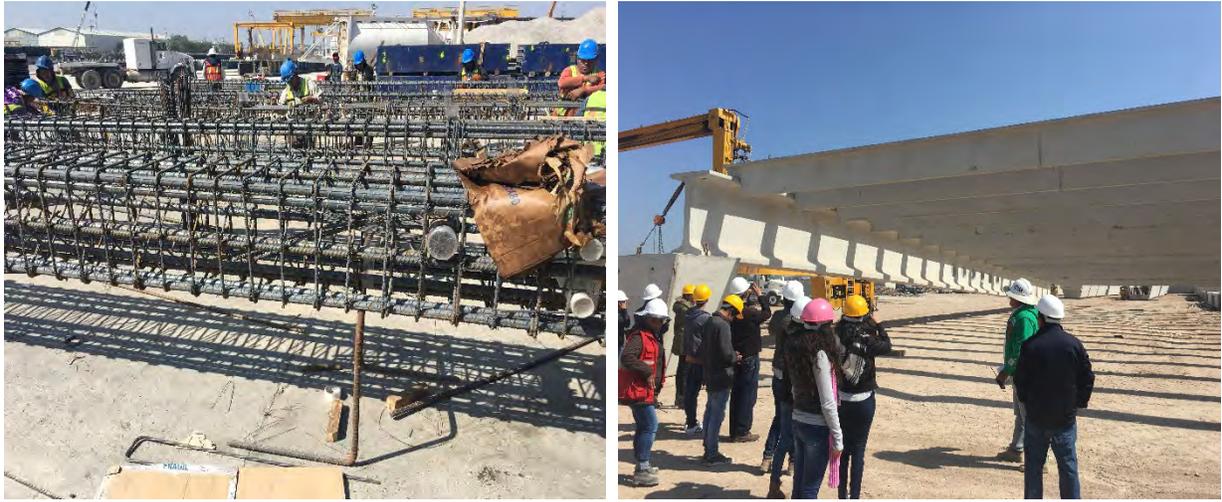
Visita con los estudiantes a plantas de producción de elementos estructurales prefabricados de concreto.
